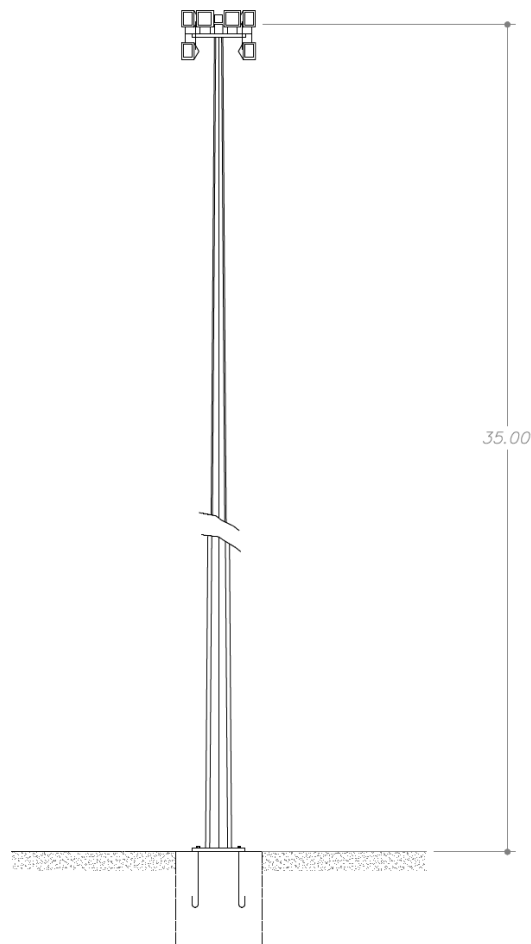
Tipologico torre faro per l'illuminazione di impianto.
